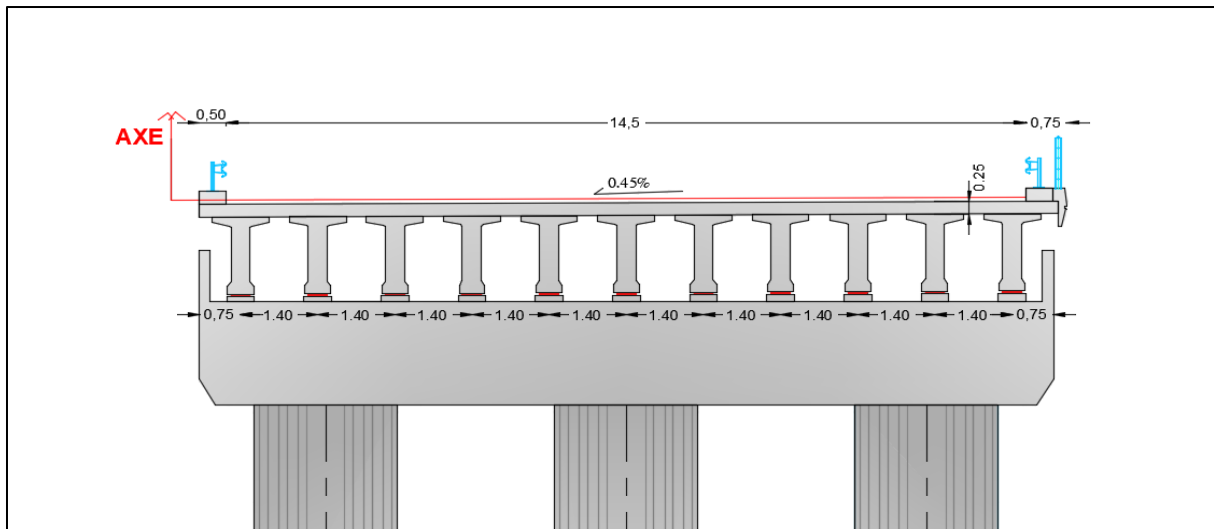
Coupe transversale sur le tablier au niveau de la pile.
